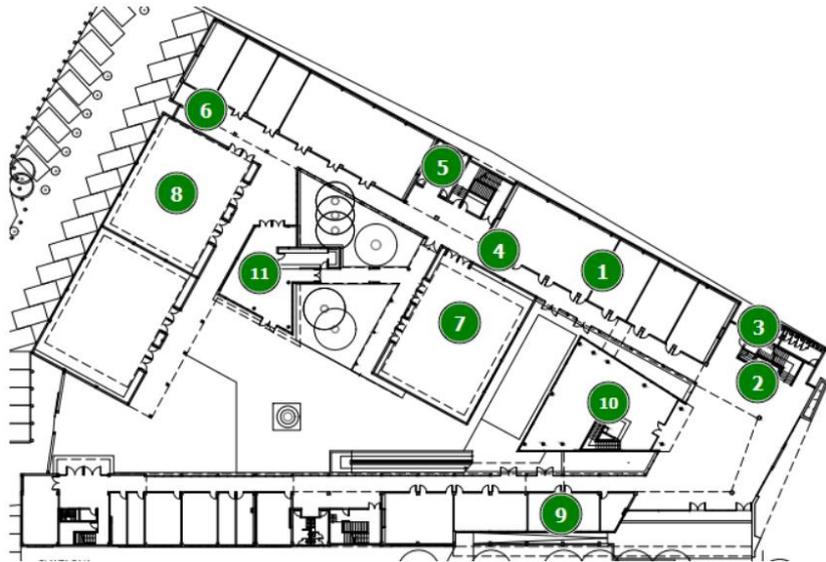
Facultad de Informática (UNLP). Puntos de interés en la planta baja.
